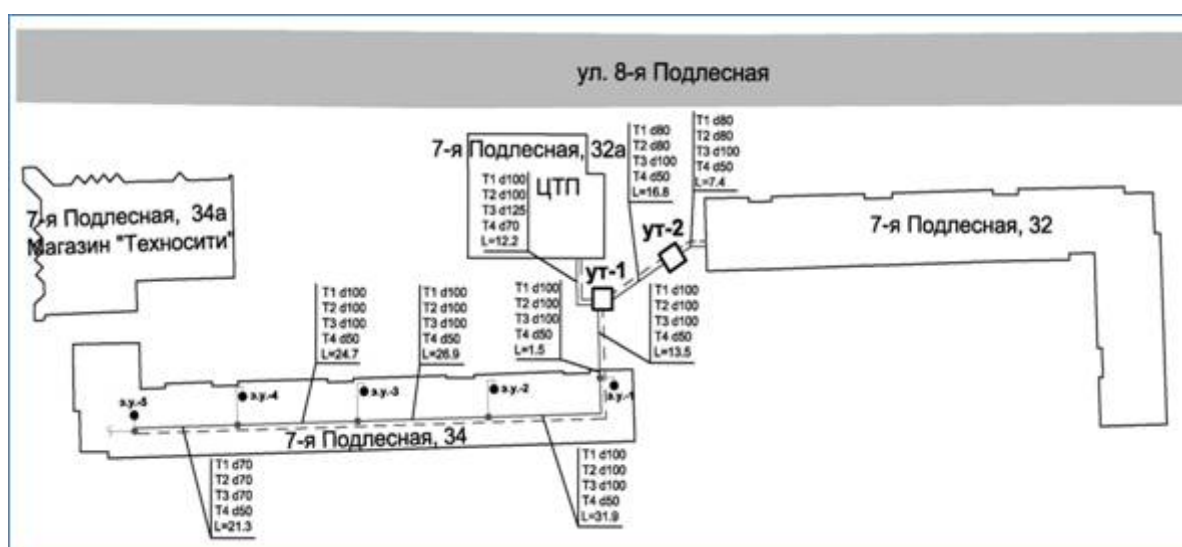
Схема теплоснабжения зданий опытной площадки от ЦТП
